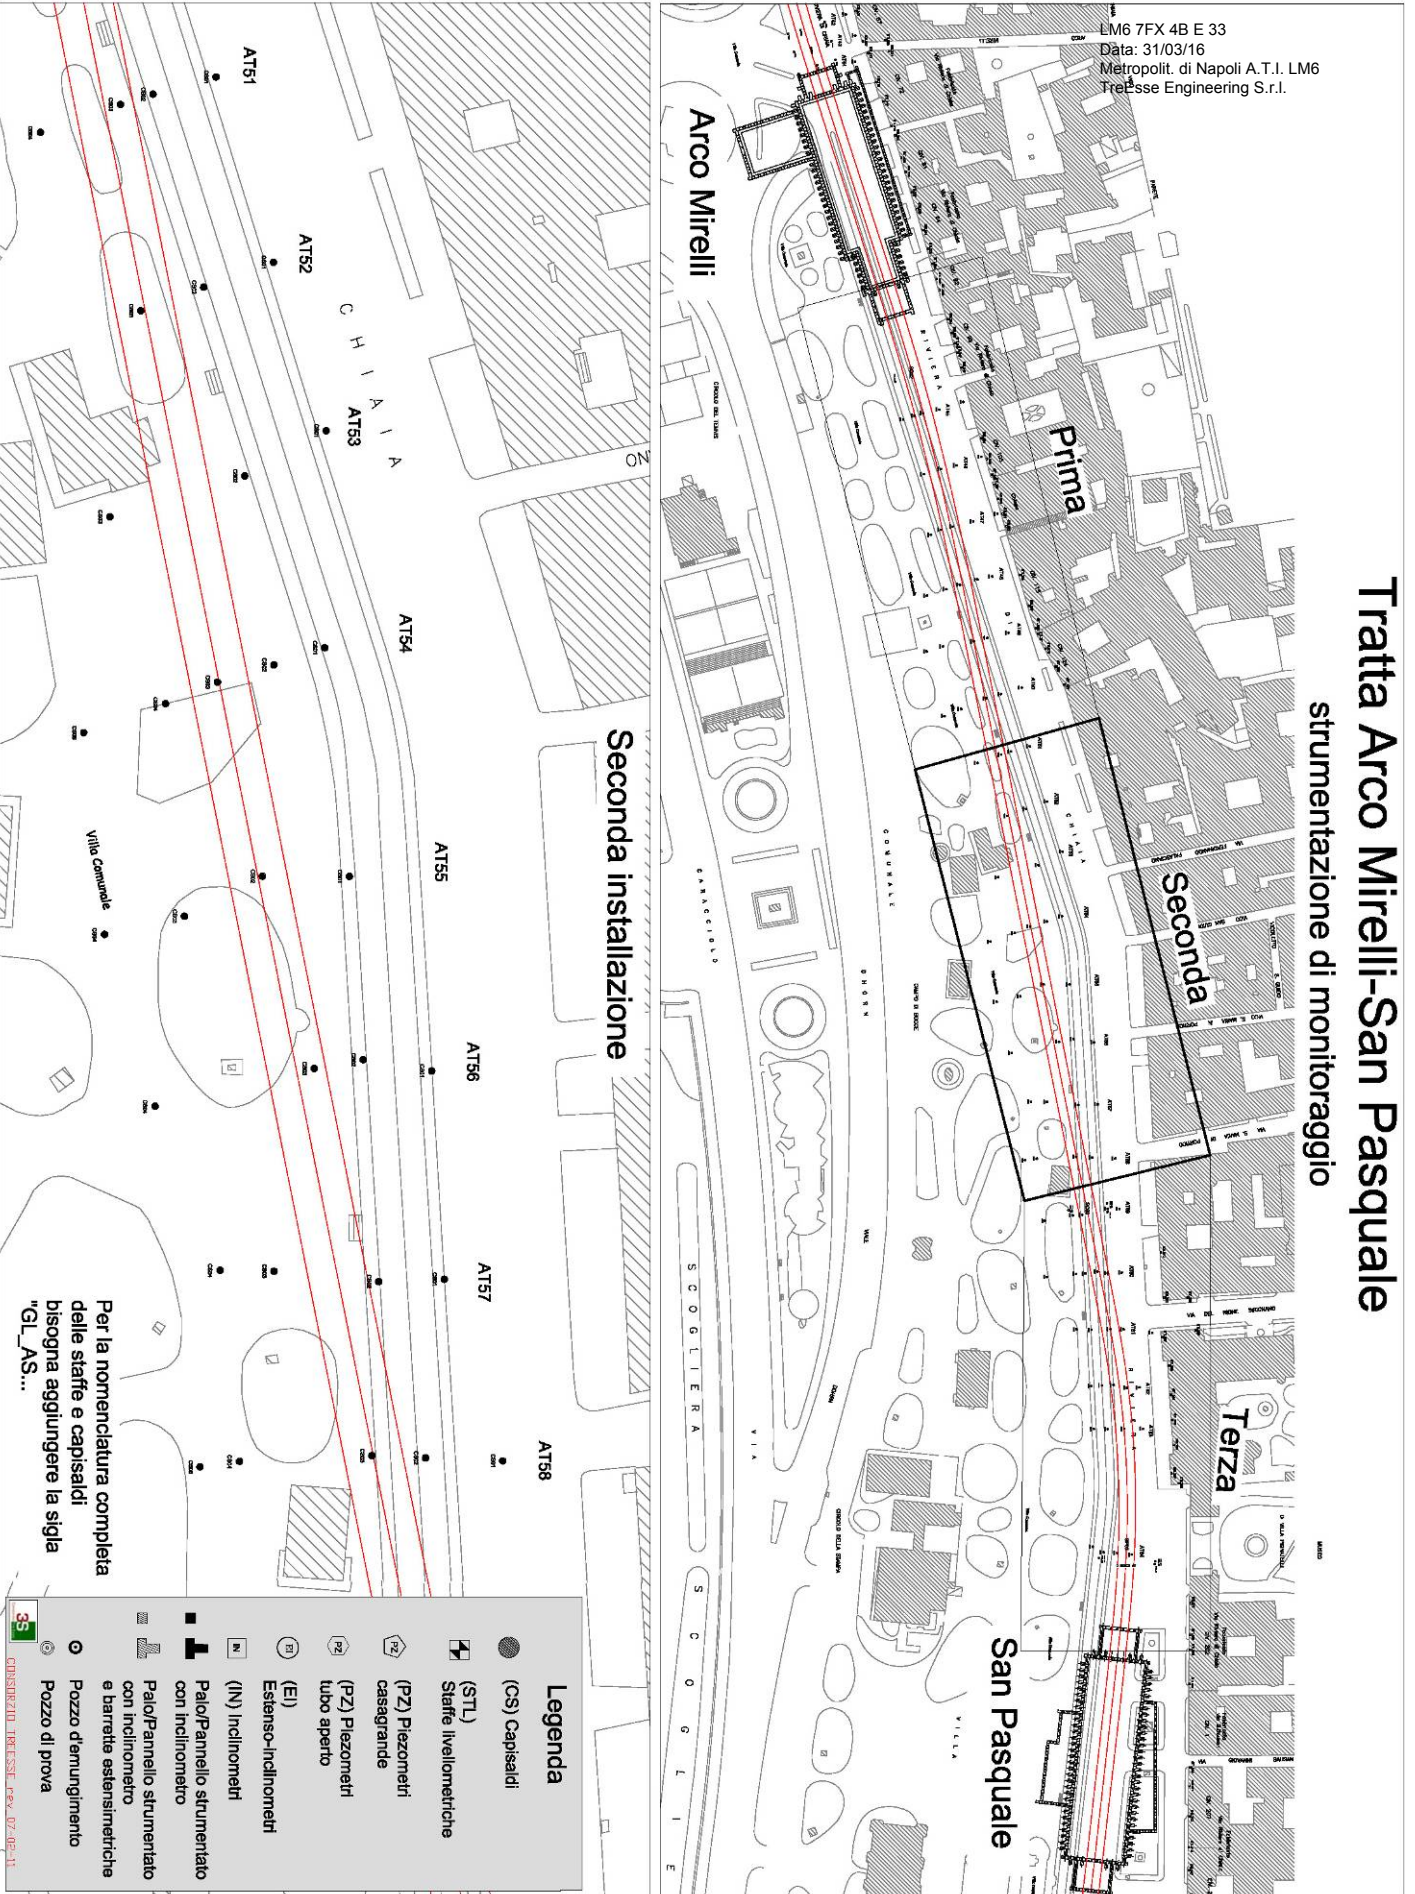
Planimetria tratta Arco Mirelli-SanPasquale, raffigurante la disposizione della seconda installazione della strumentazione di monitoraggio.
